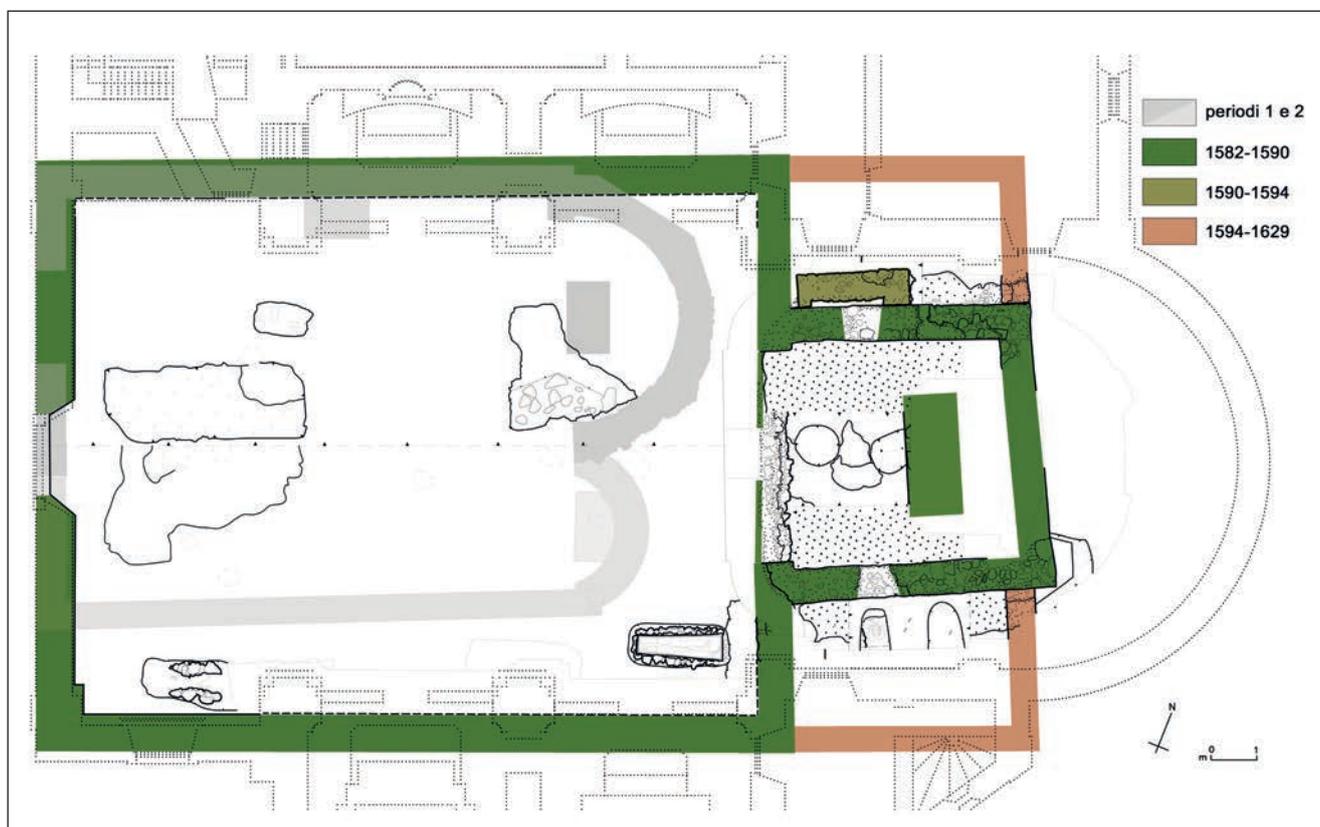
San Maurizio d'Opaglio. Chiesa parrocchiale. Planimetria della terza ricostruzione (1582-1629) (ril. M. Zapelloni; elab. L. Pejrani Baricco).
